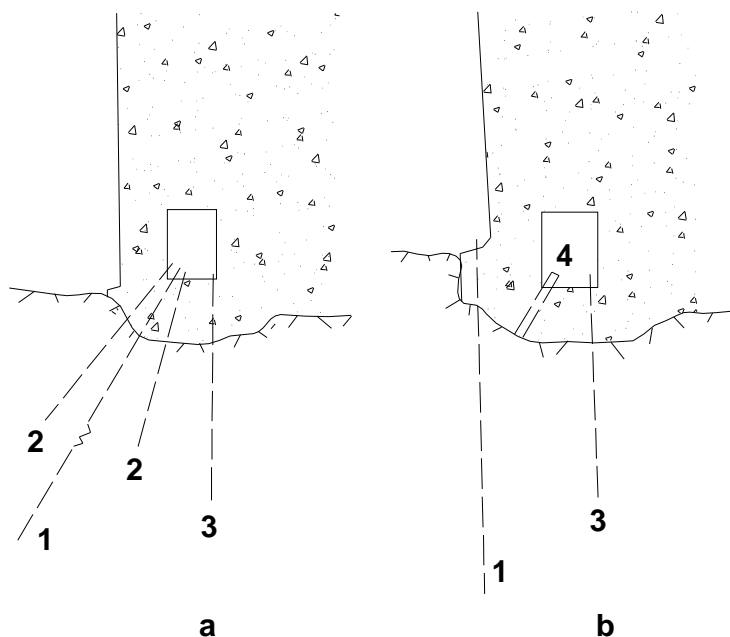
Esquemas alternativos ou complementares de injeção junto ao paramento de montante de estruturas de concreto dotadas de galerias de drenagem. (1) – furos para injeção profunda, (2) – furos para injeção rasa, (3) – furos de drenagem, (4) – tubos guia deixados através da armadura para eventual reforço da injeção a partir da galeria. No esquema a, os furos (2) são executados antes dos furos (1). (MARQUES FILHO, 1986)
